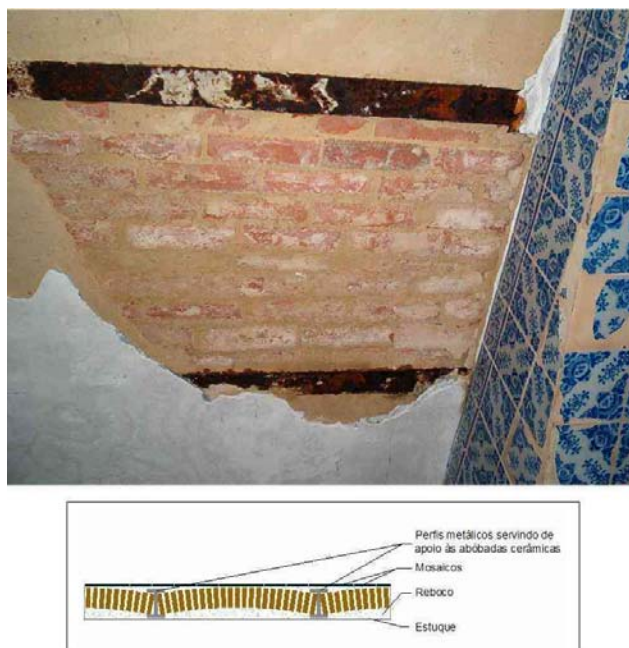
Abobadilhas cerâmicas do pavimento do 2º piso
